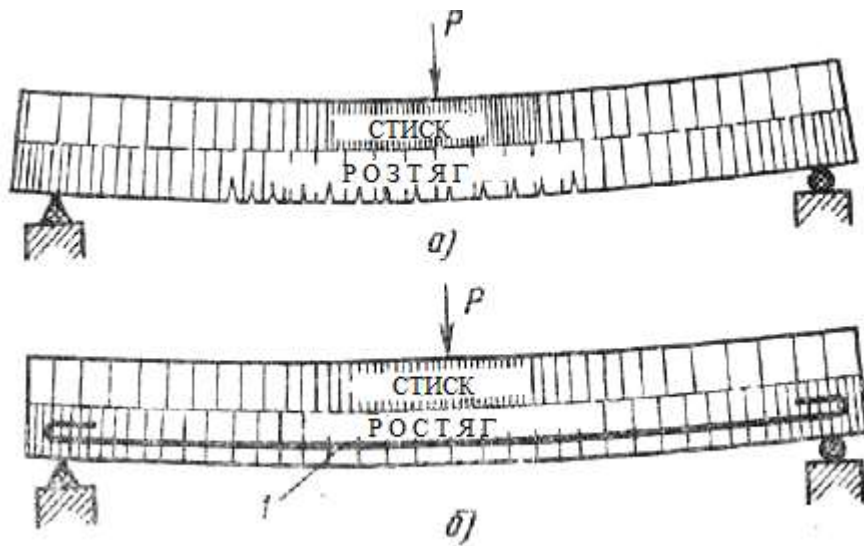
Неармована бетонна (а) і армована залізобетонна (б) балка;
